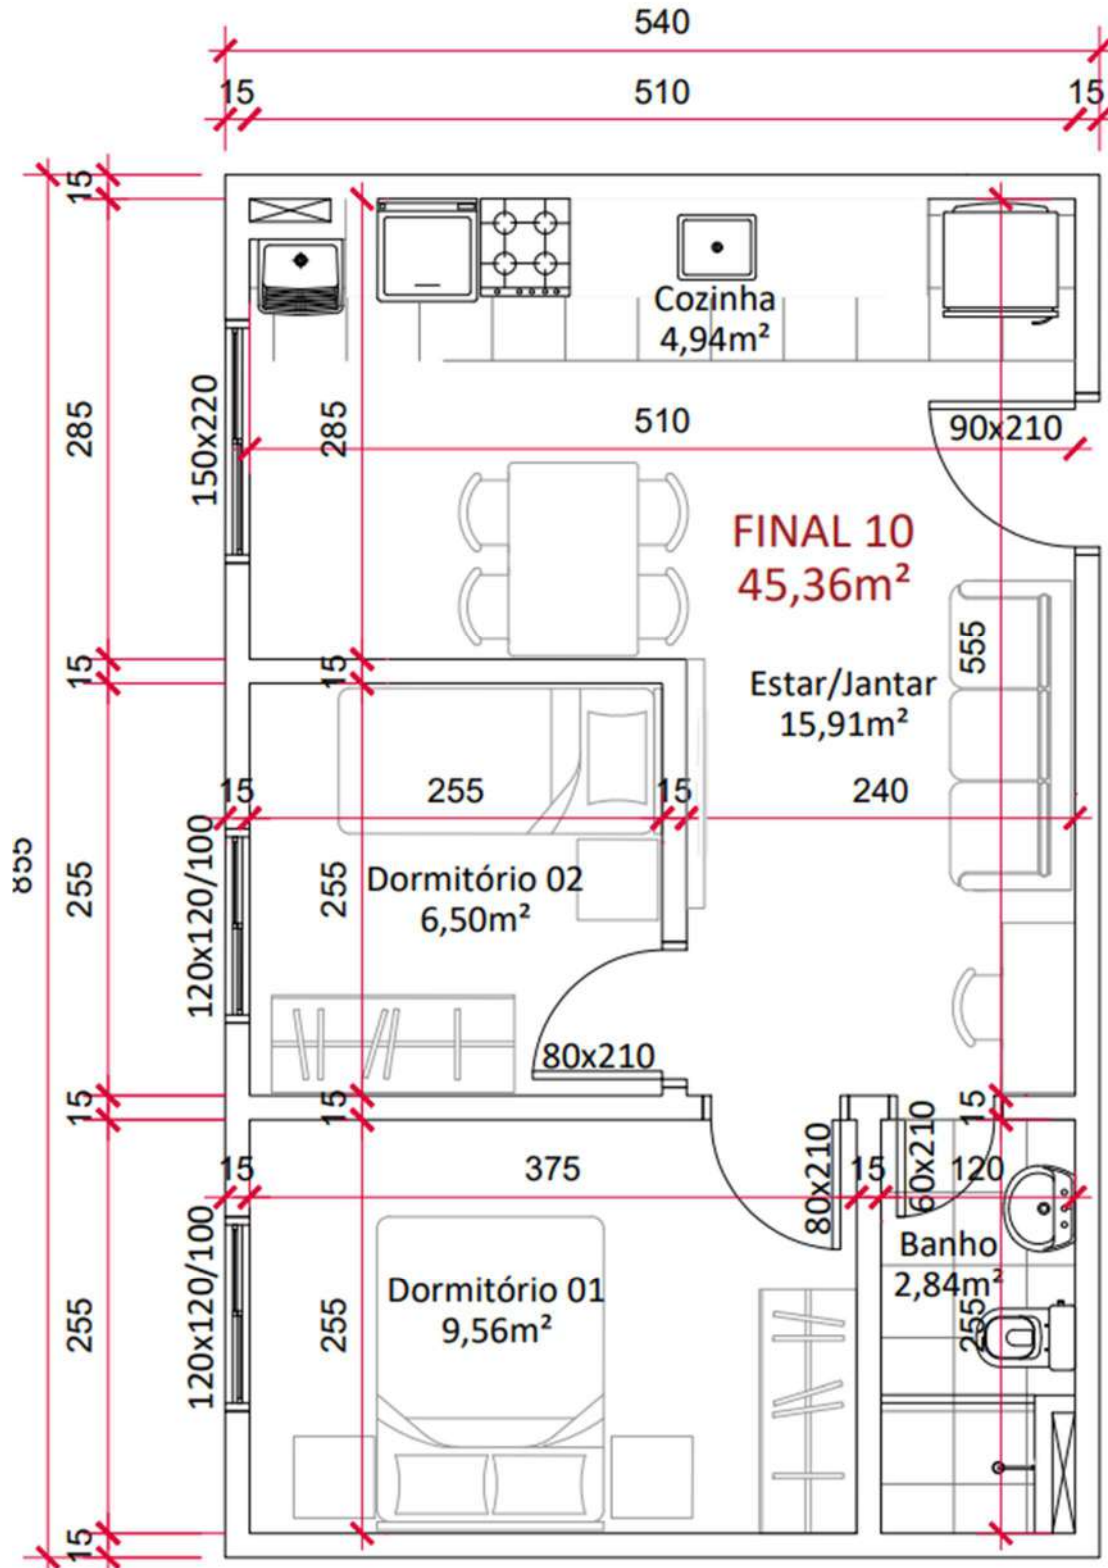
Planta Baixa dos pavimentos tipo e térreo apartamentos final 10 e 09
